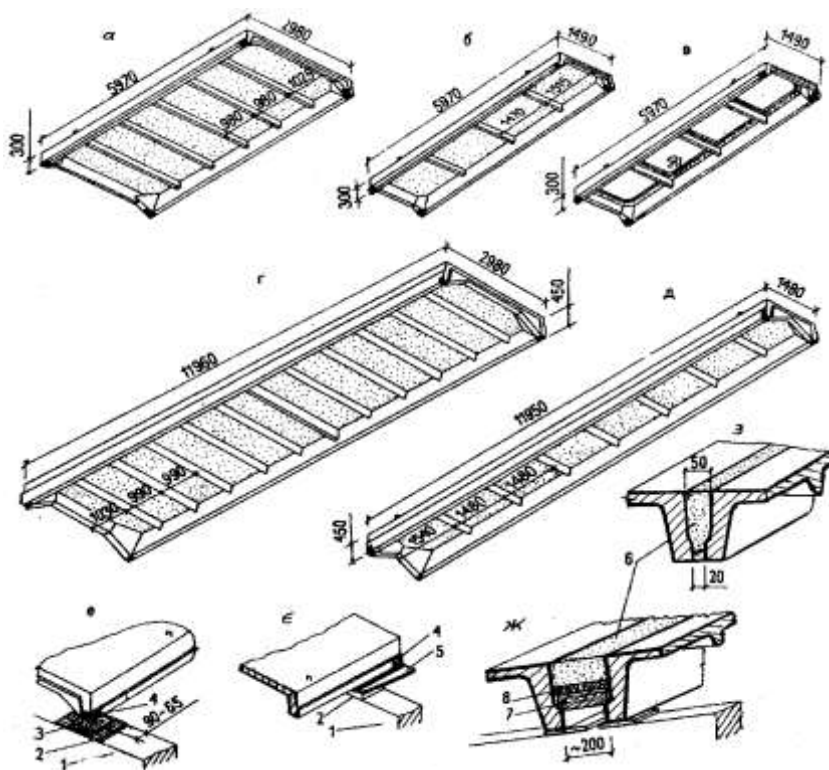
Залізобетонні плити покриття (вигляд знизу). Деталі кріплення. а – основні (6х3 м); б – добірні (6х1,5 м); в – з отворами в полиці; г – основні (12х3 м); д – добірні (12х1,5 м); е – оперття плити на кроквяну конструкцію; є – оперття плит біля торцевих стін чи деформаційних швів; ж – забування швів при укладанні плит на сегментну ферму; з – забування швів шириною до 50мм; 1 – кроквяна балка чи ферма; 2 – закладна деталь; 3 – стальна підкладка; 4 – закладна деталь ребра панелі; 5 – виносна опорна планка; 6 – бетон або розчин; 7 – дерев'яний брус; 8 – дошка.
